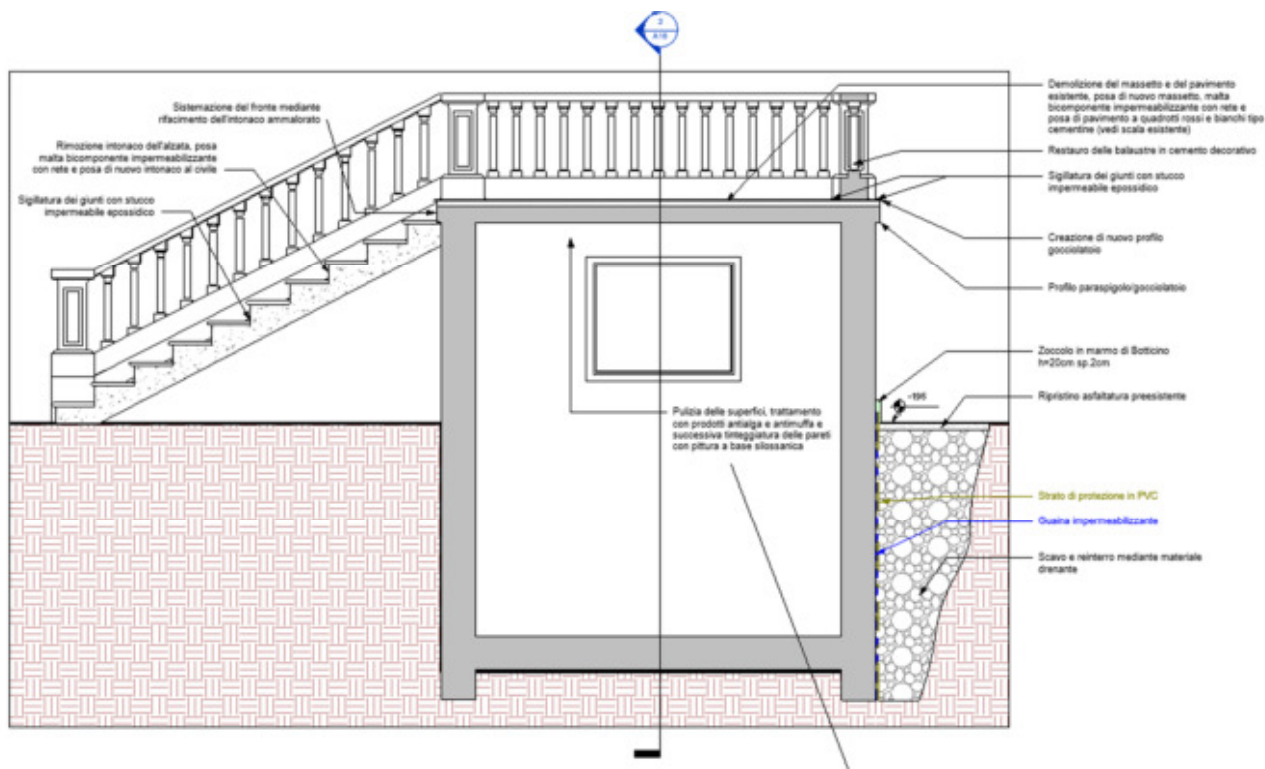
Restauro conservativo delle scale esterne 02 – Sezione A
